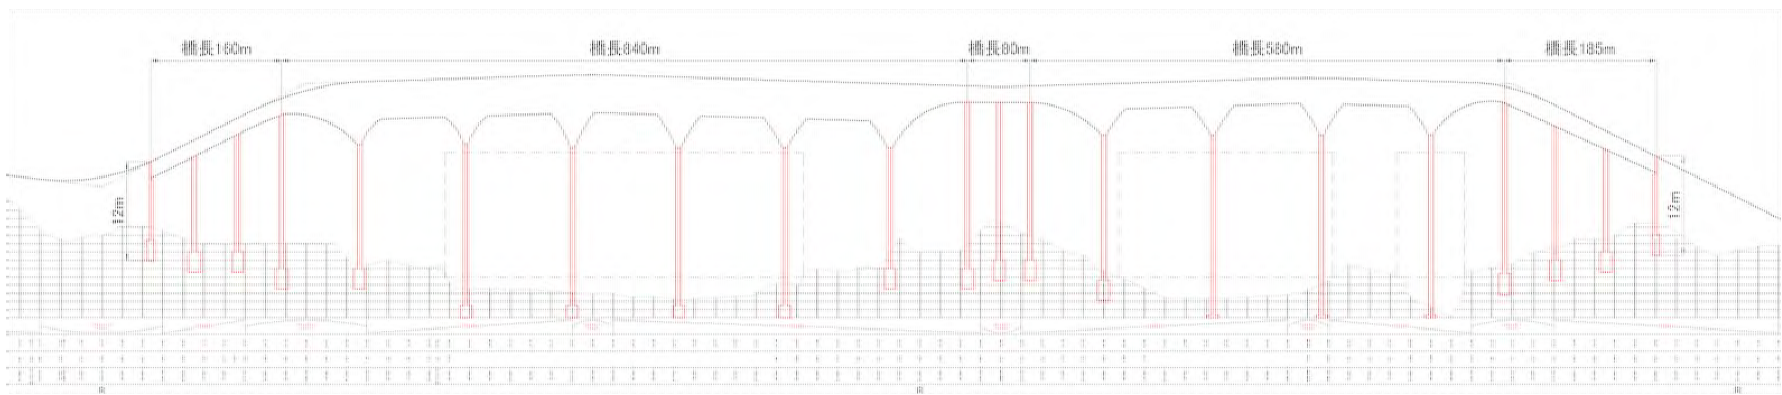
平面縦断面図 (ボナストンベ〜ジェバル島)
